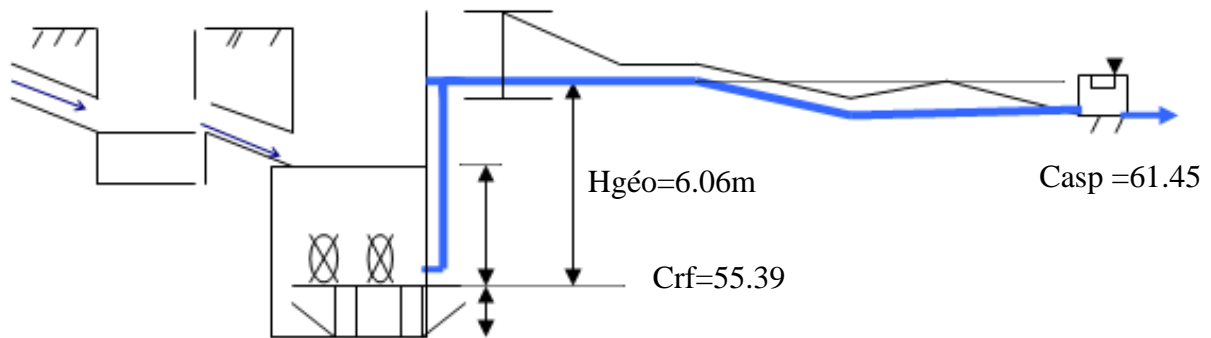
Plan déterminer la hauteur géométrique Hgéo.
